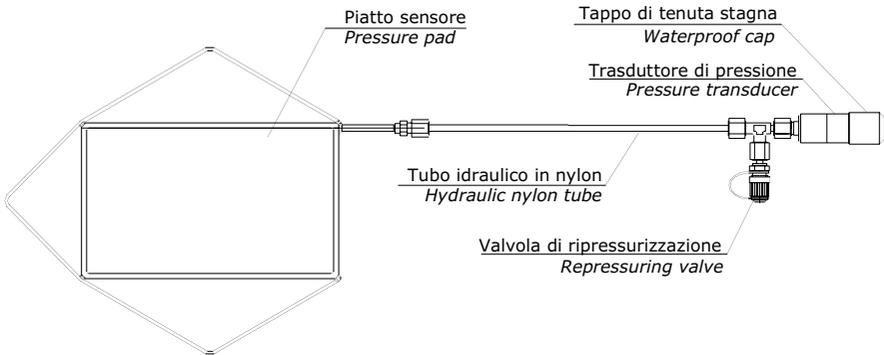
Componenti cella di pressione per calcestruzzo
